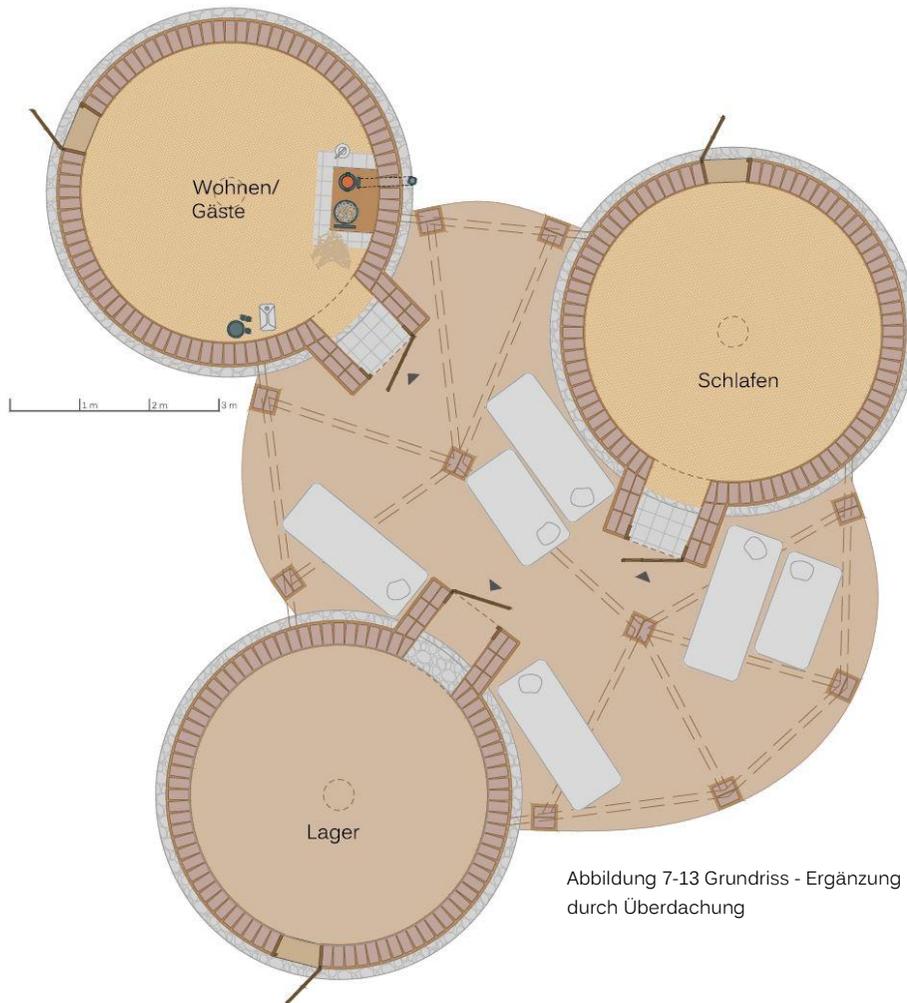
Grundriss - Ergänzung durch Überdachung
